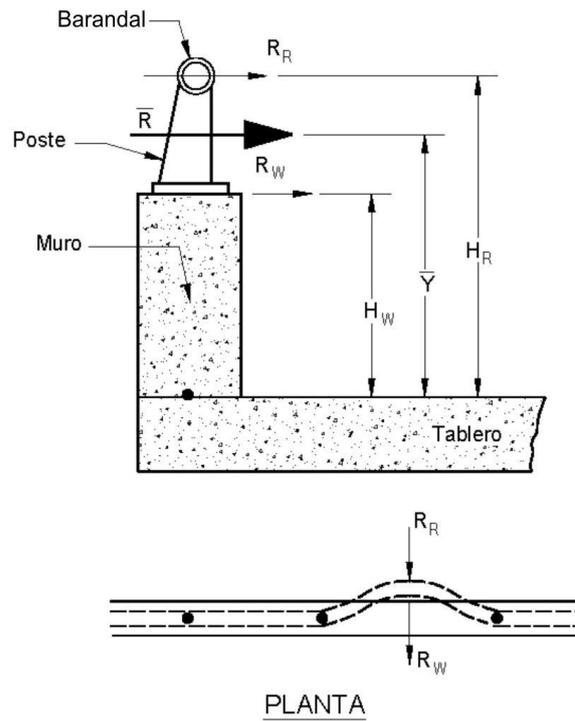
Evaluación del conjunto formado por un muro de hormigón y una defensa metálica – Impacto en la mitad de la longitud de la defensa
